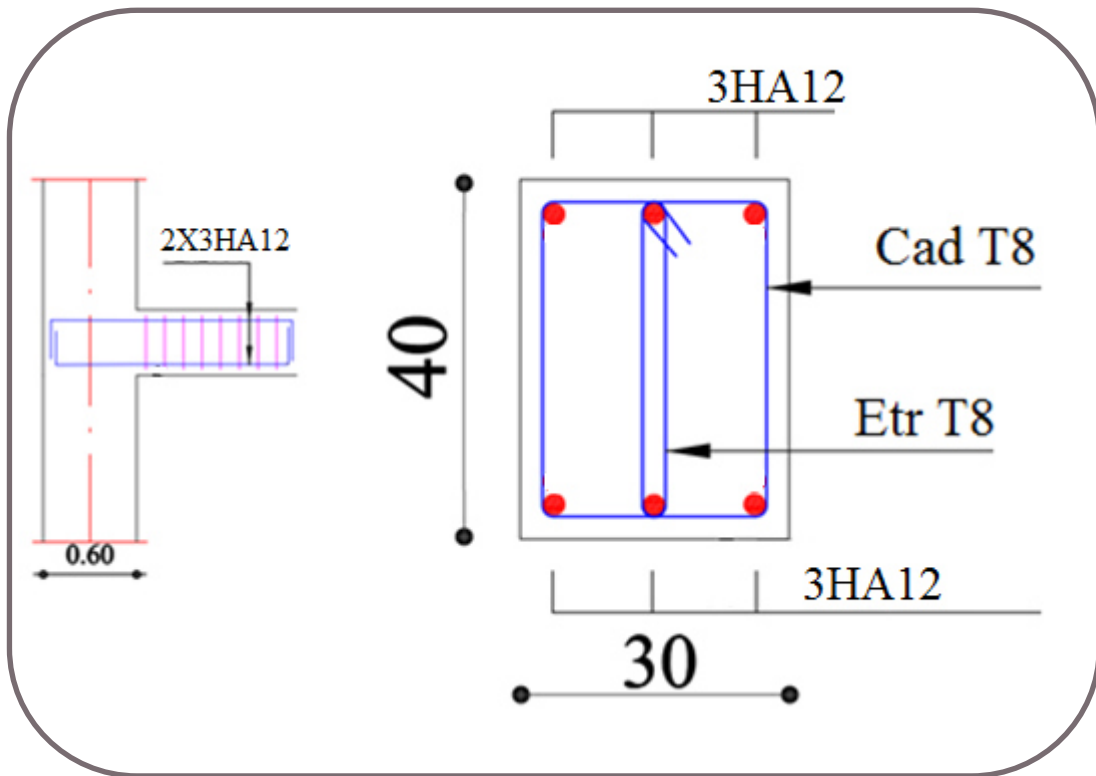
Schéma de ferrailage de consol escalier RDC.
